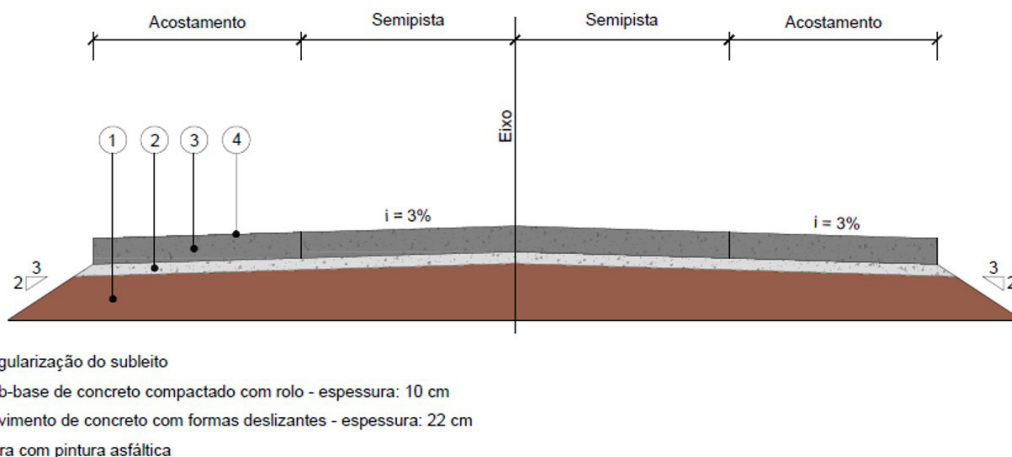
Perfil da solução-tipo G (pavimento de concreto de cimento Portland) [adaptado de: DNIT, 2019].
